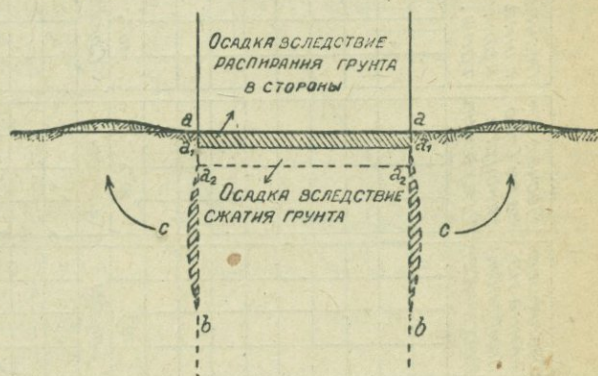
Нагрузка отведенной под постройку площади при горизонтальной поверхности фундамента сооружения.
